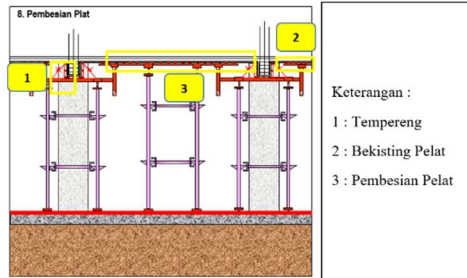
47 Detail 1 Bekisting Balok dan Pelat
